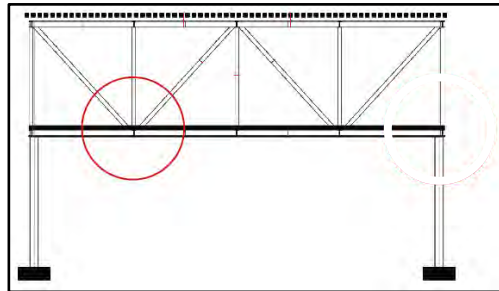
Detalle Estructural - Anclaje viga sobre columna
